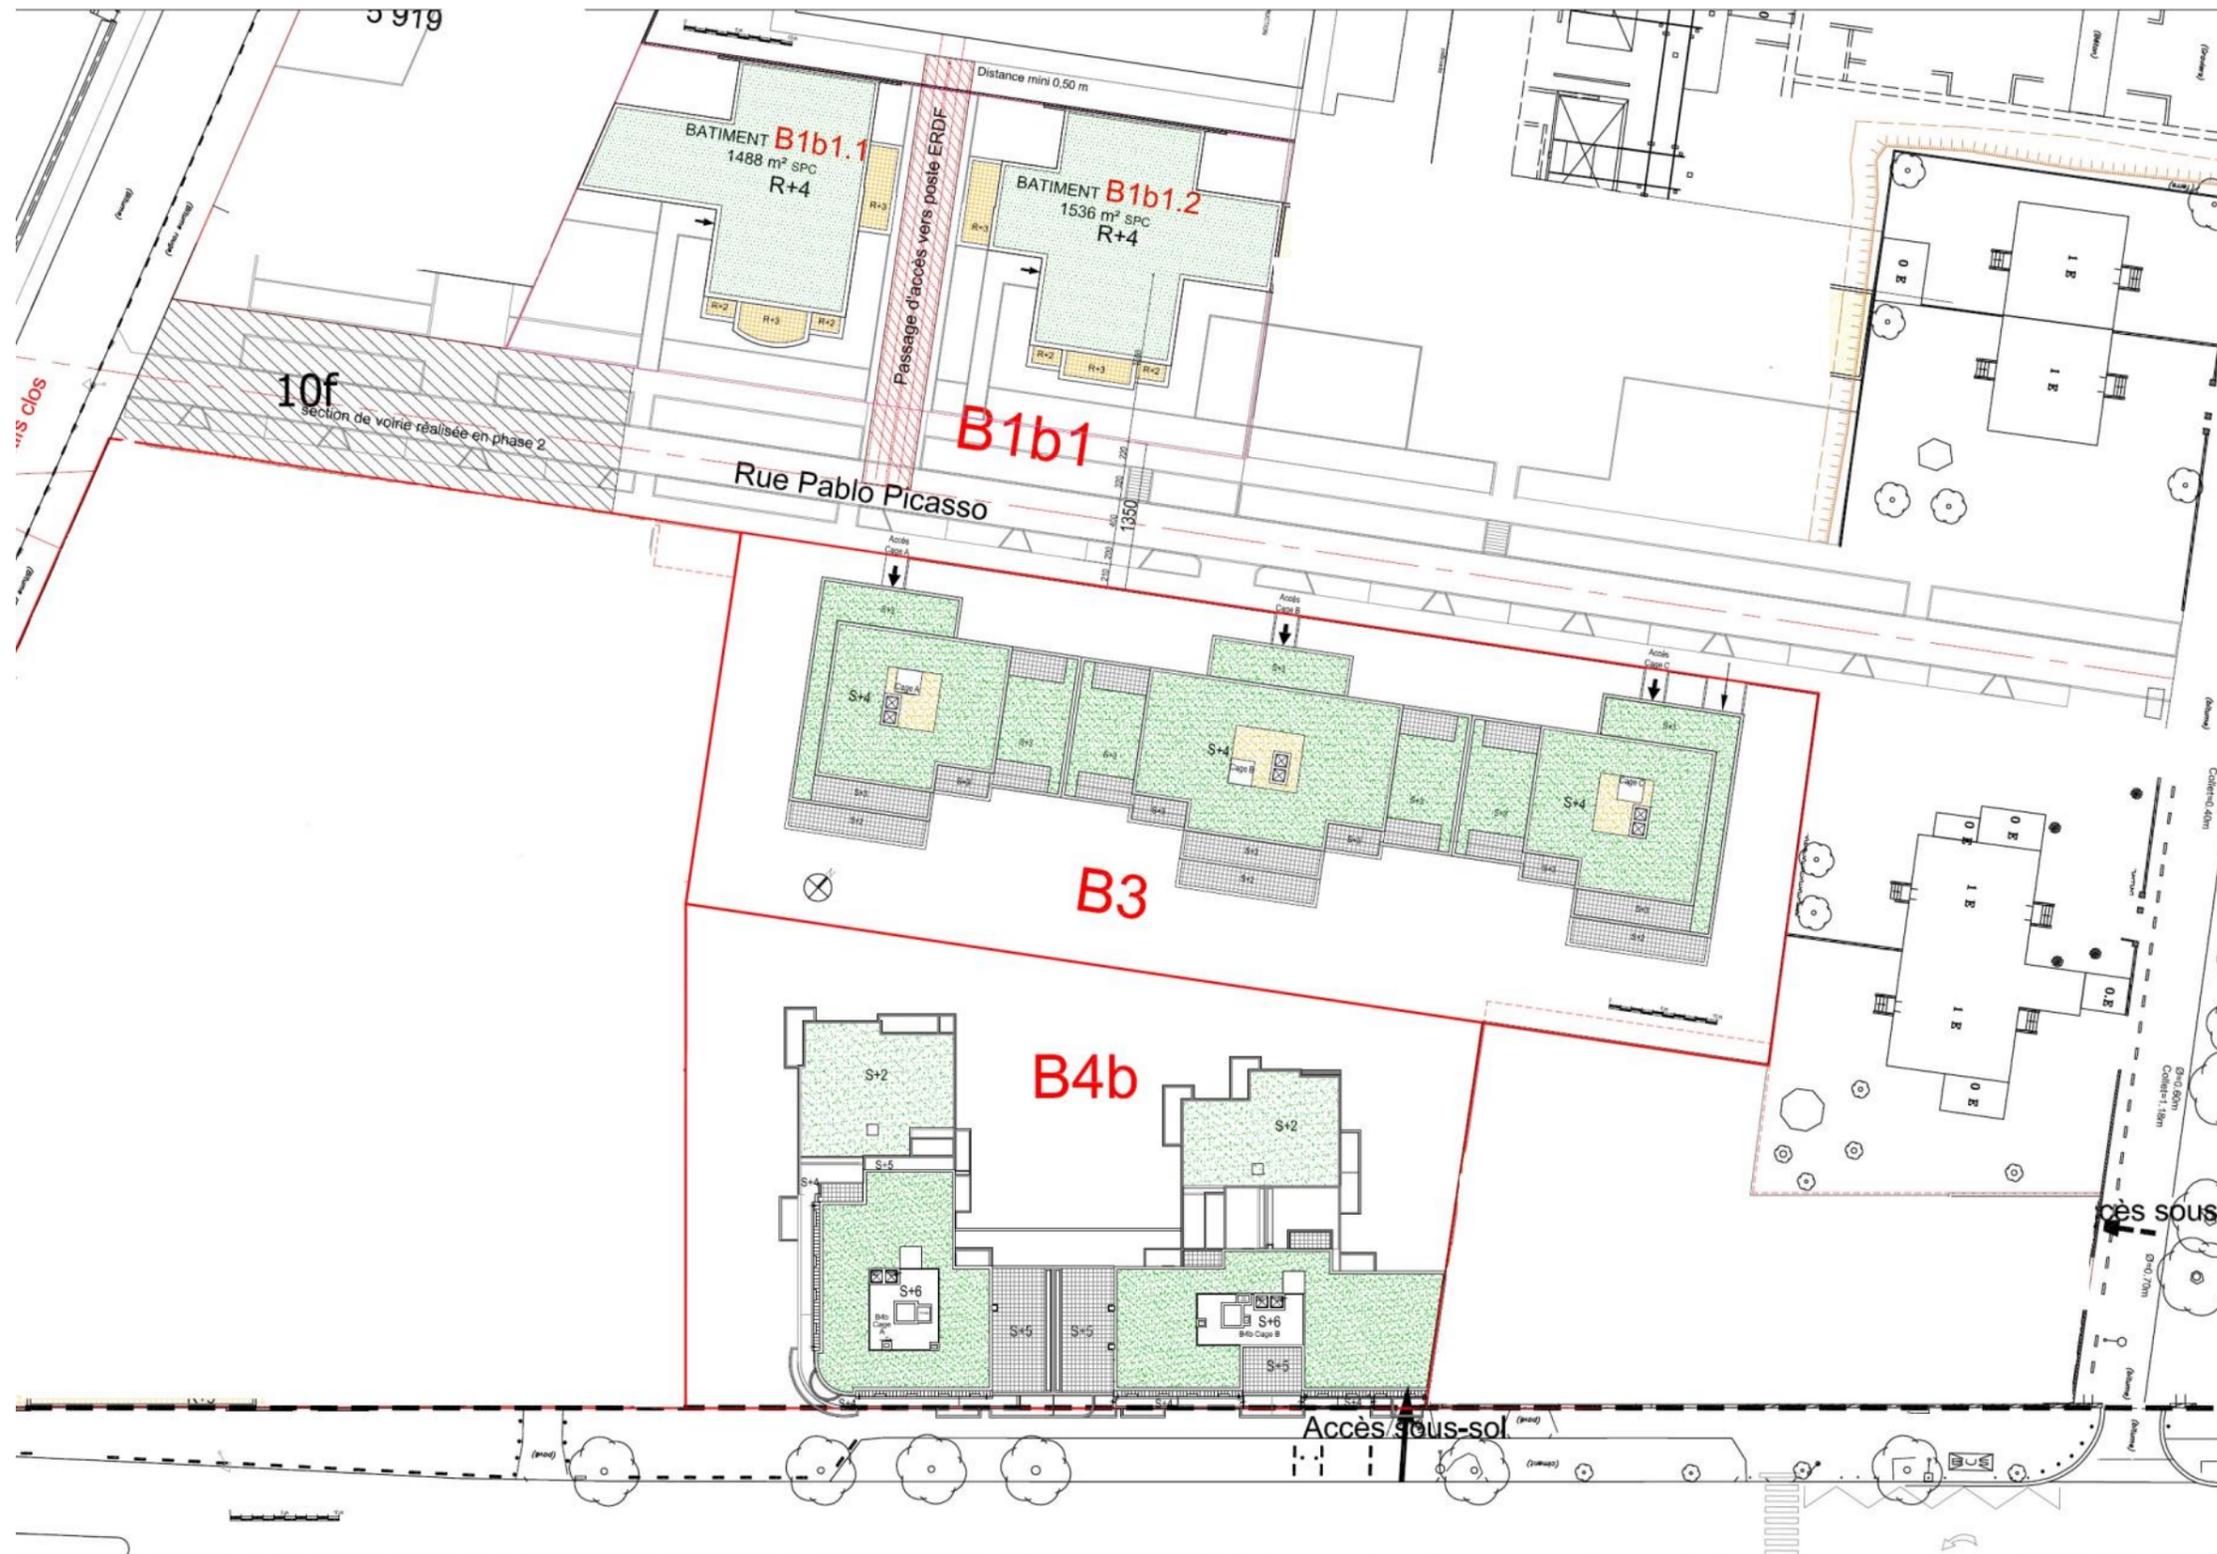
Plan masse du projet ; îlots B1b1, B3 et B4b inclus dans le secteur 3A (au 22/06/2015)
